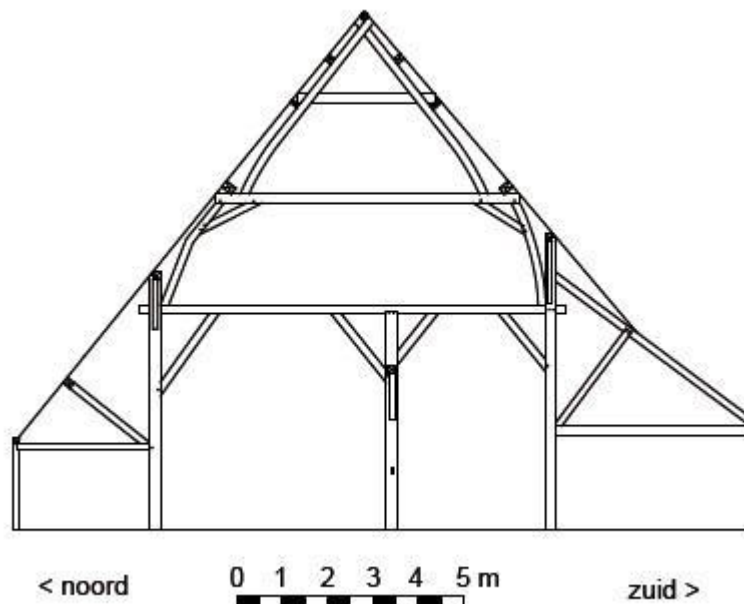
Reconstructie 'schoone groote schuere', Oude Arenberg 1690 (langsdoorsnede)
